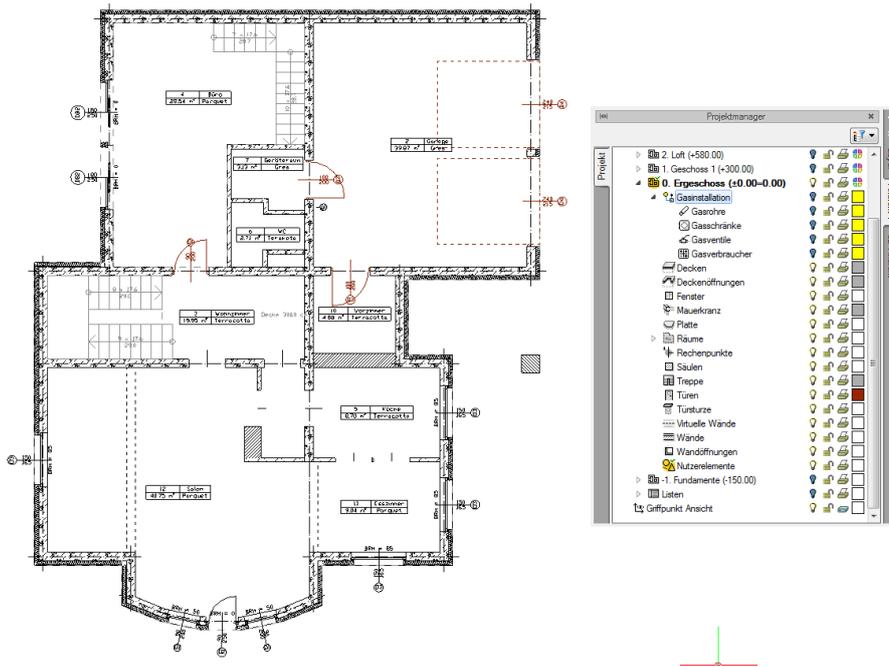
Grundriss eines Geschosses nach dem Ausblenden der Gasinstallationenelemente
